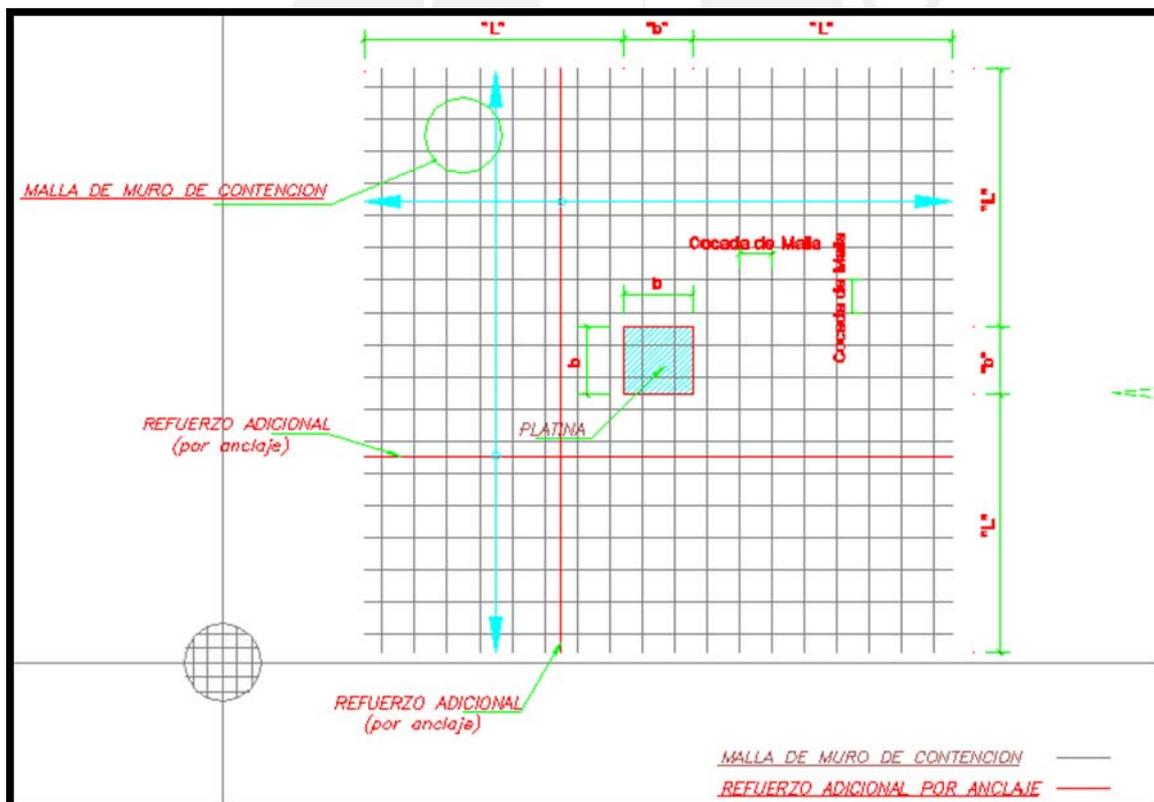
Refuerzo adicional en muros anclados OBRA 1
